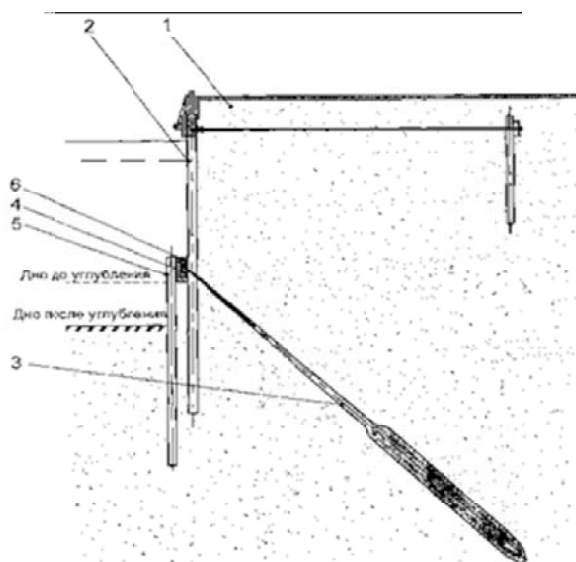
Способ закрепления стенки наклонными грунтовыми анкерами
